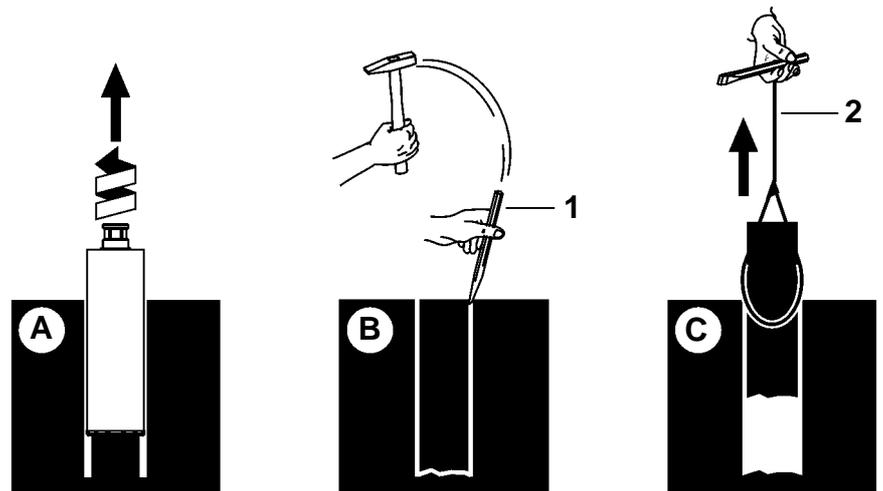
Bohrkern-Ausbauvorrichtung
